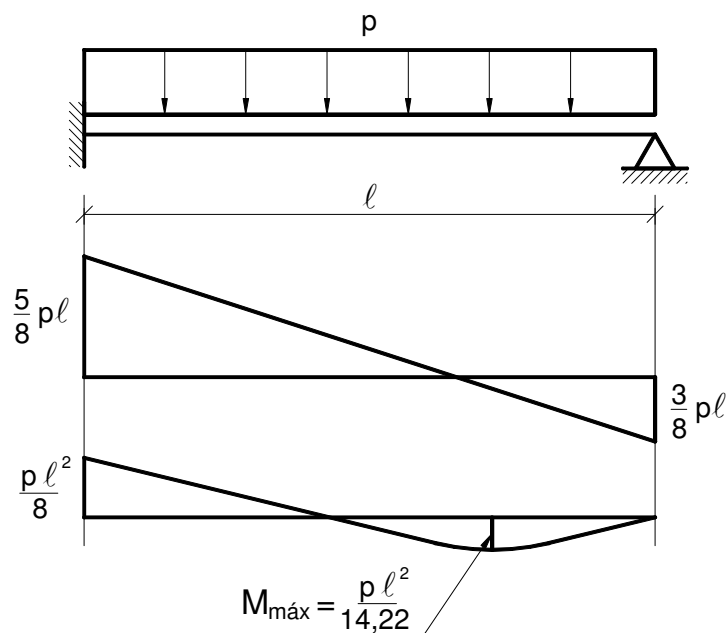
Laje armada em uma direção sobre apoio simples e engaste perfeito com carregamento uniforme.
